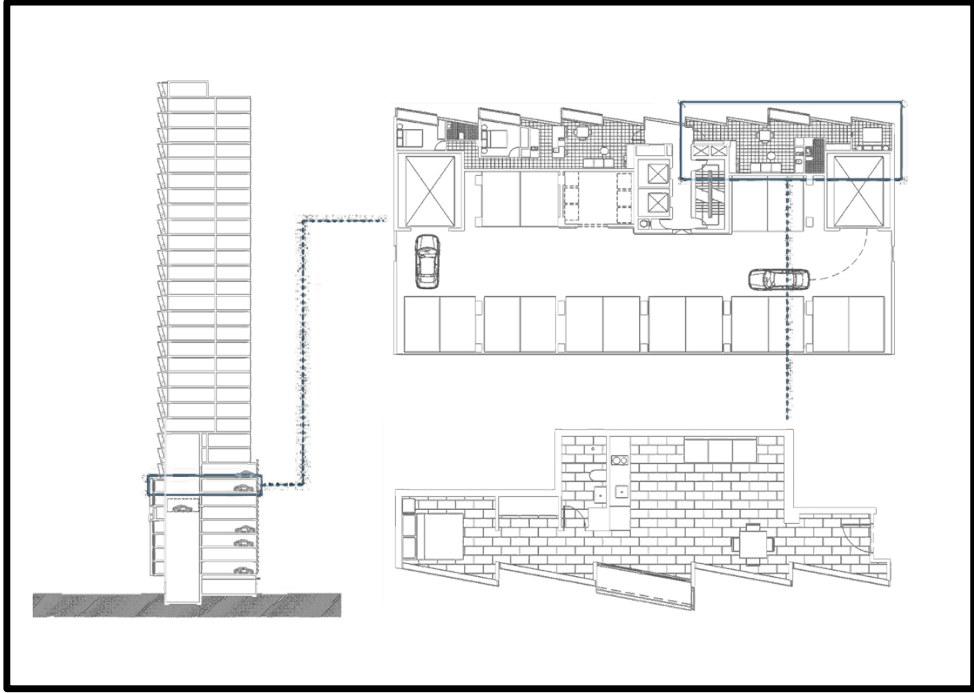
A' Beckett Tower Otopark Katı Planı (URL- 49)
